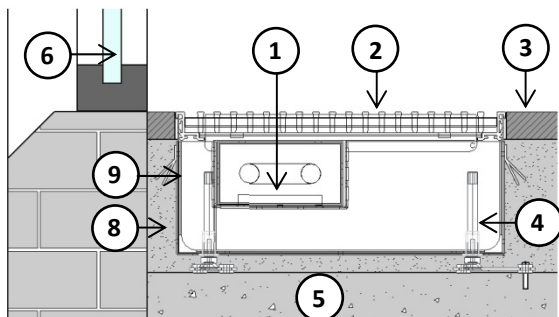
dettaglio di un montaggio in pavimenti in cemento
